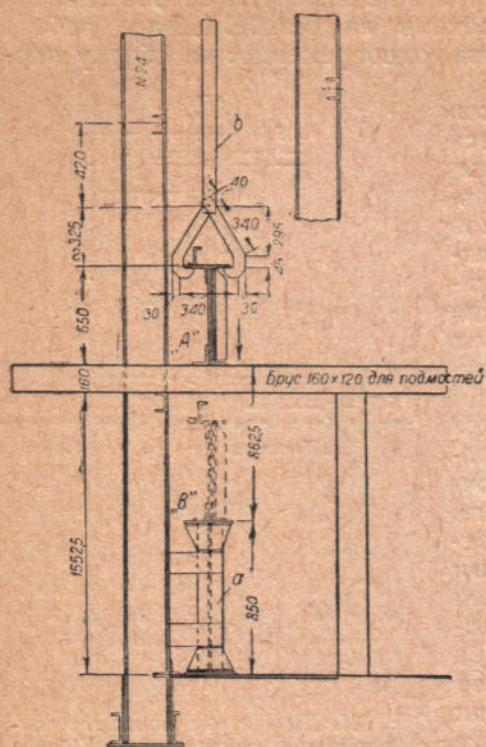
Приспособление для монтажа шайбы газгольдера „Кlöppel“
